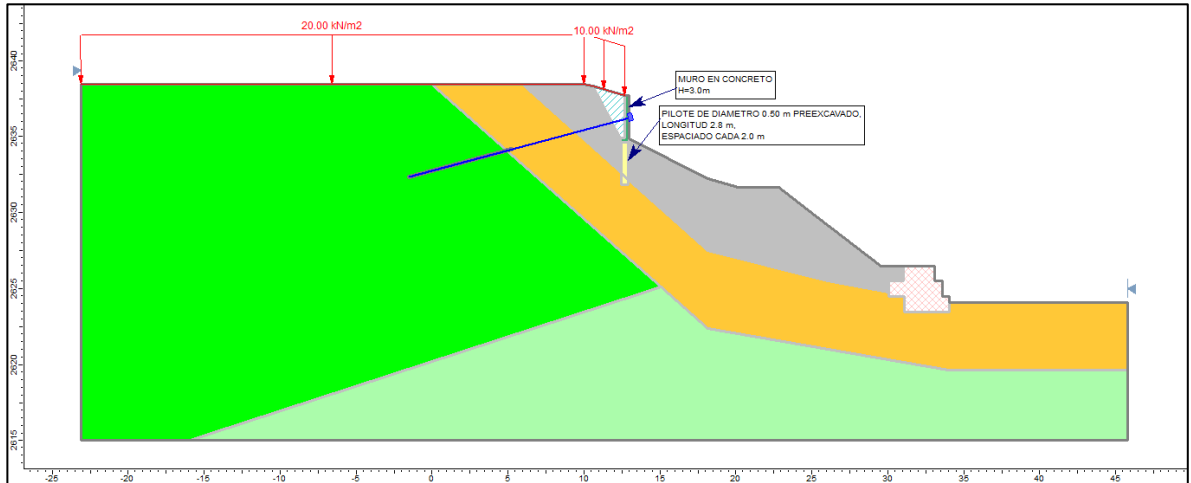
Esquema de muro de contención con pilotes de concreto en la base de diámetro 0.5 m espaciados cada 2.0 m
